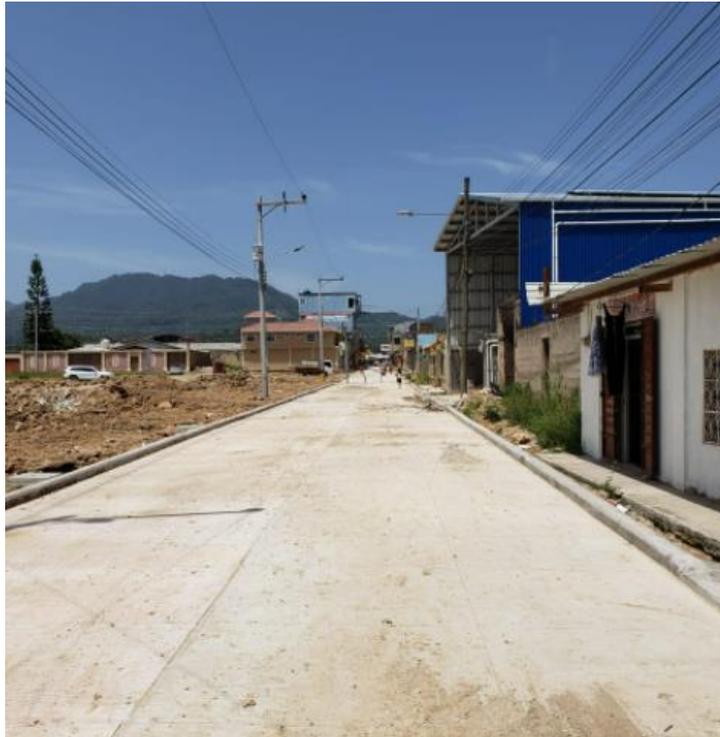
Pavimento Hidráulico de barrio La Pista
